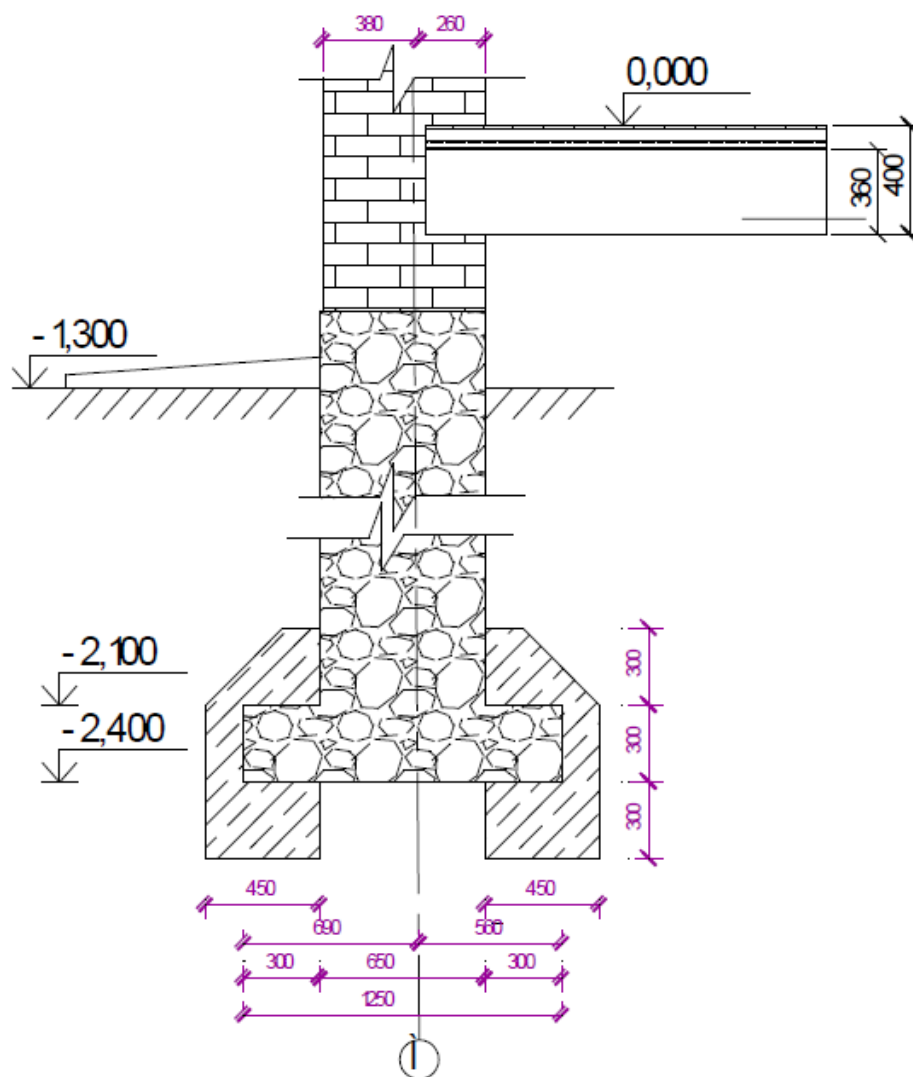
Усиление фундамента под наружную стену с омоноличиванием уступа
